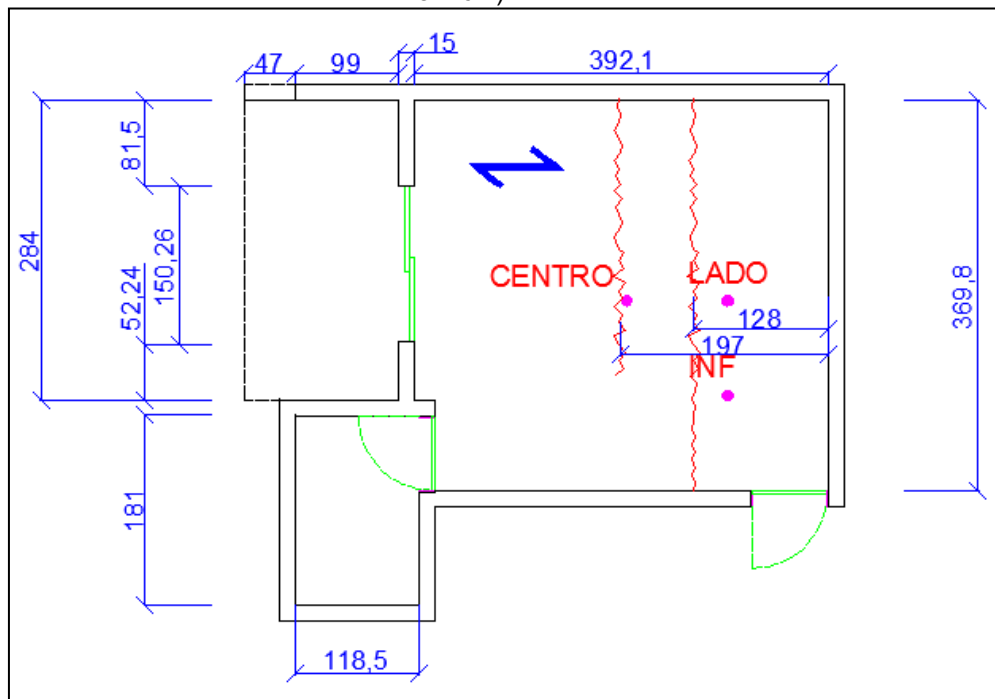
croqui da casa 3A com representação das fissuras e pontos de ensaio (dimensões em cm)
